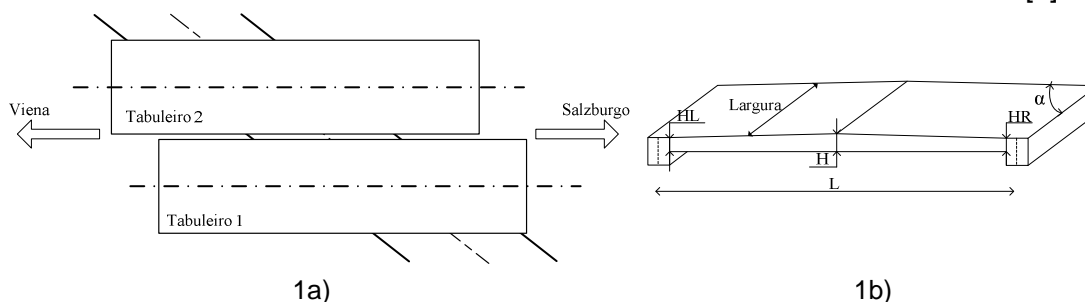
a) Vista em planta da implementação da ponte com a indicação dos eixos das vias-férreas nos tabuleiros; b) Caracterização estrutural - geometria.
